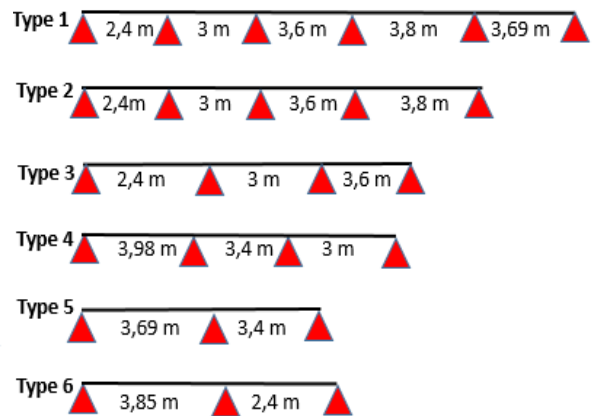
Types des poutrelles dans la terrasse inaccessible
